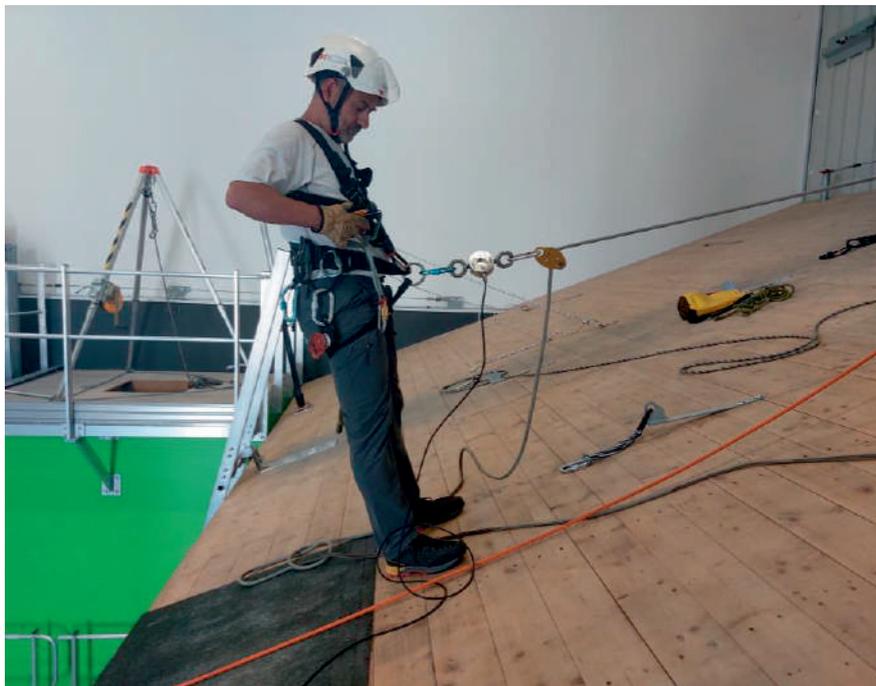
Sistema di posizionamento sul lavoro
